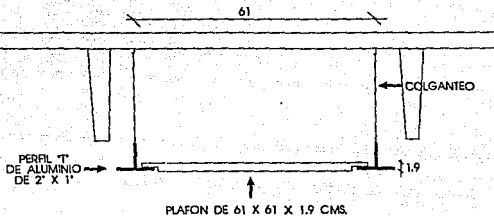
DETALLE DE COLGANTES DE PLAFON
